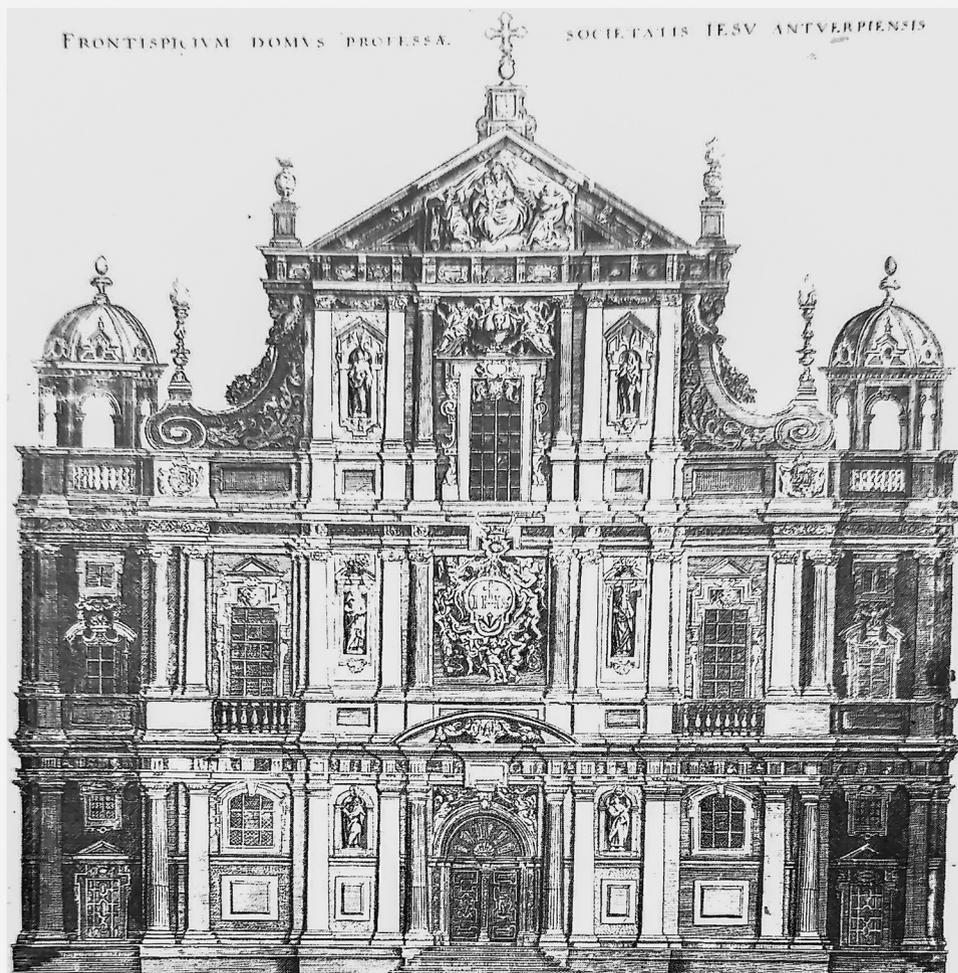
Antwerpen, Jesuitenkirche, Fassade. Stich De la Barre
